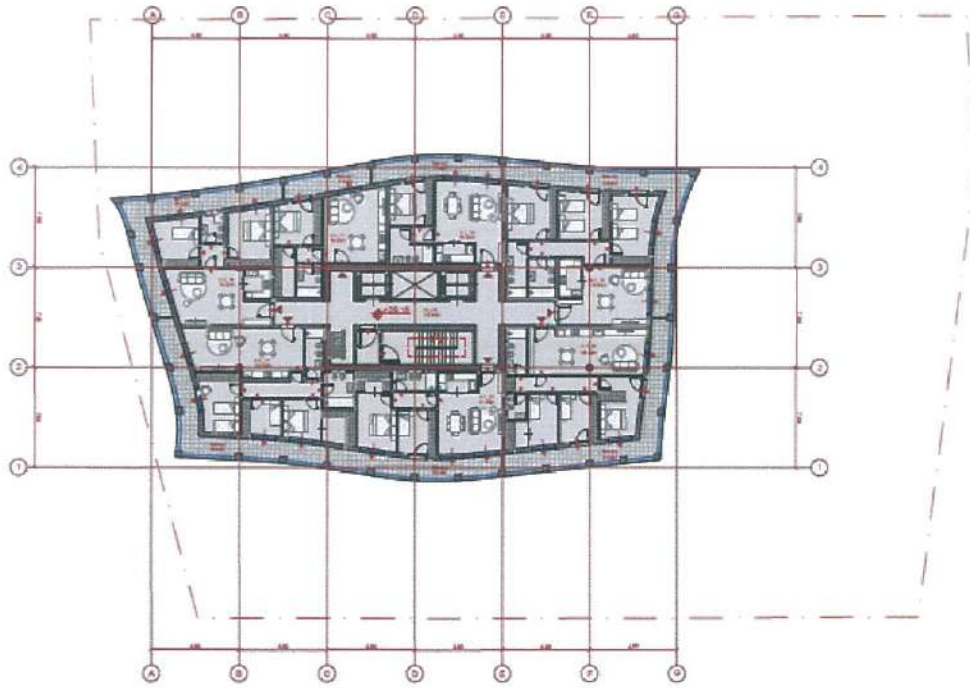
Planimetria e katit 6, në kuotën +26.18 SIP 945 m²
